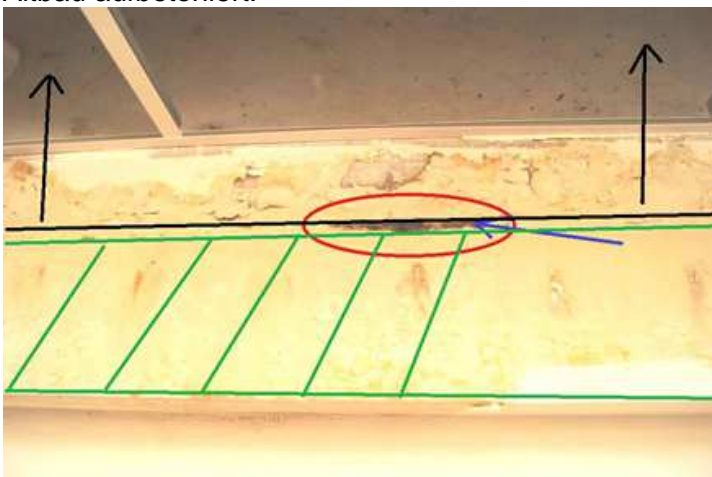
Wasseraustrittsstelle + Bauteilkonstruktion
